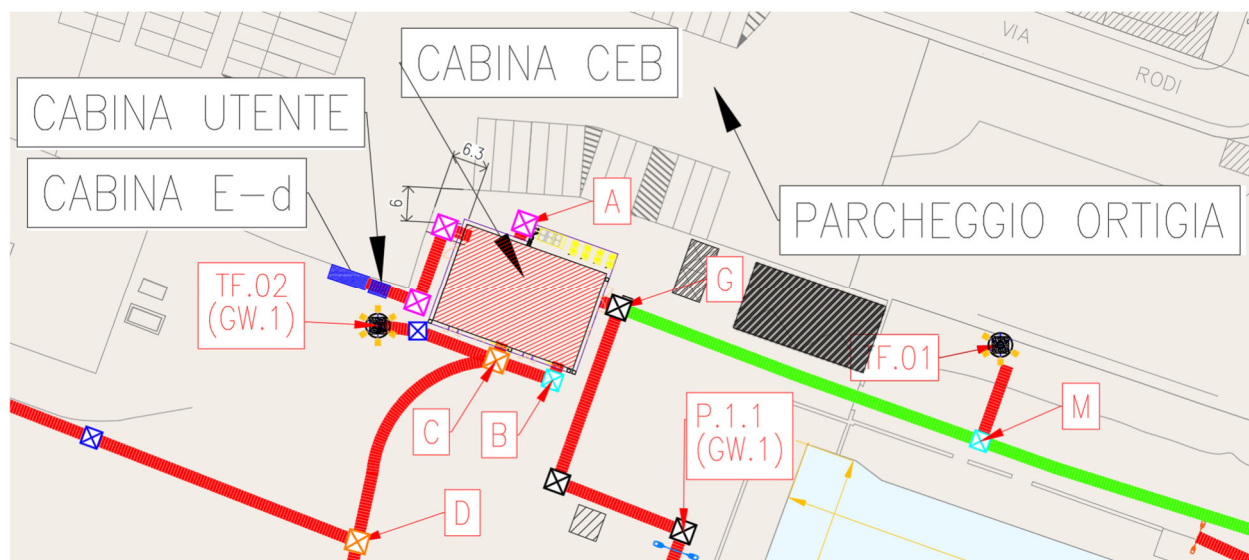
Particolare vie cavi di nuova realizzazione _ Stralcio della planimetria di progetto (elaborato 32016019PE0GENDIS03)
